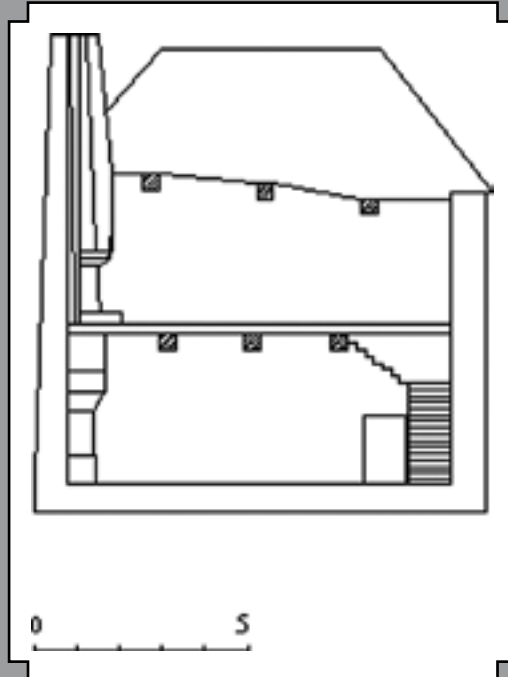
Bédée, la Prioulais, plan en coupe est/ouest (A. Le Meur).
